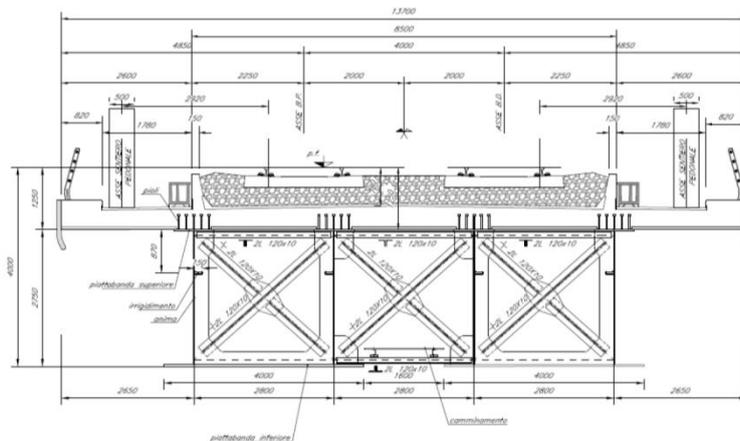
Sezione trasversale tipo (H travi = 2.75 m)
